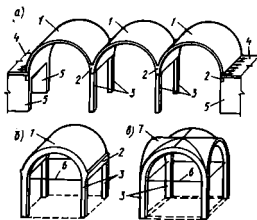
Схема погашений распора в сводах на колоннах:
